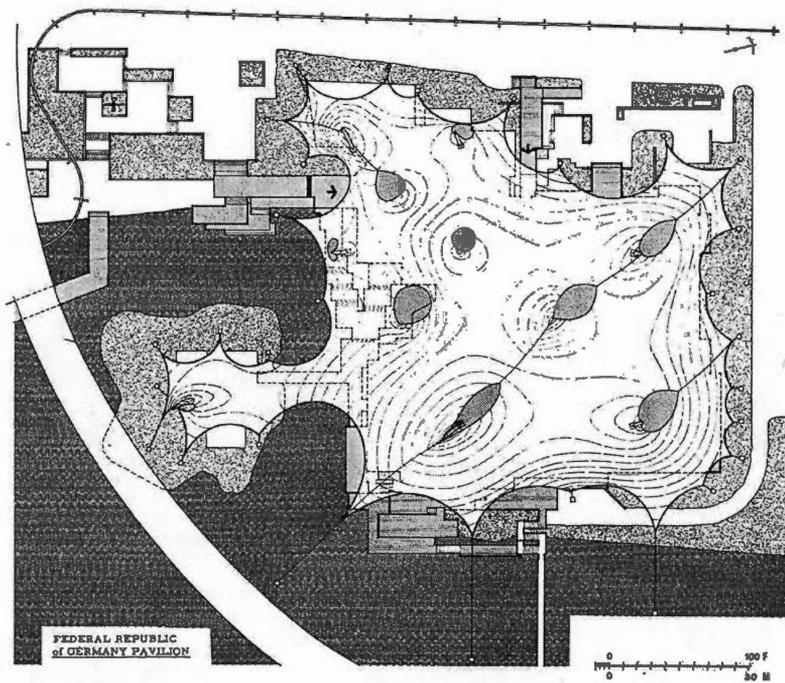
Plan du site. Pavillon de la République fédérale d'Allemagne
